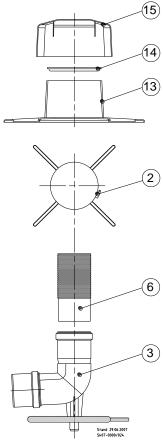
Dibujo de detalles de montaje tapa del pozo Leyenda figura 22:
